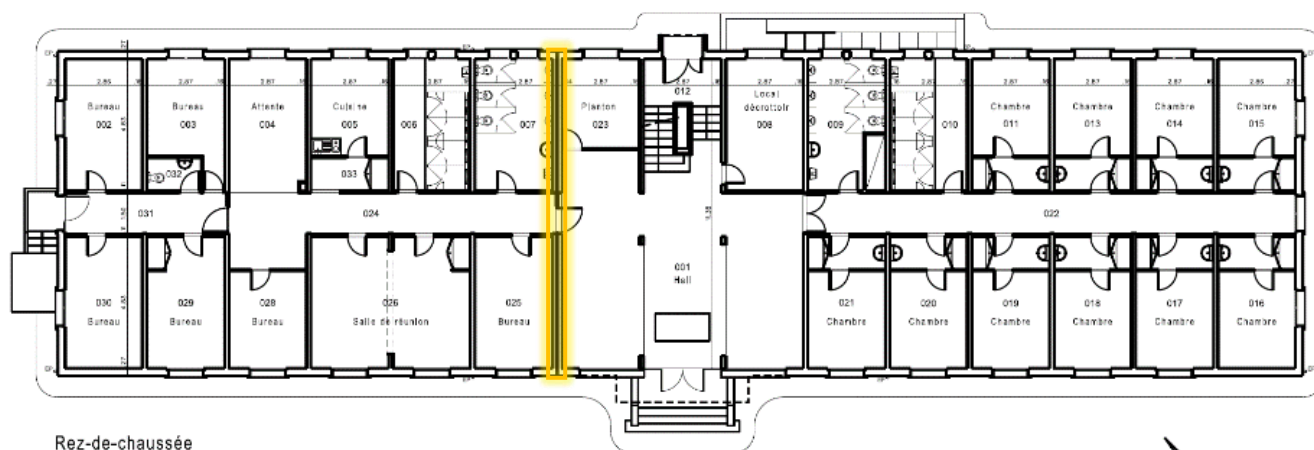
Repérage du joint de dilatation du bâtiment 2, repéré sur le plan du RDC
